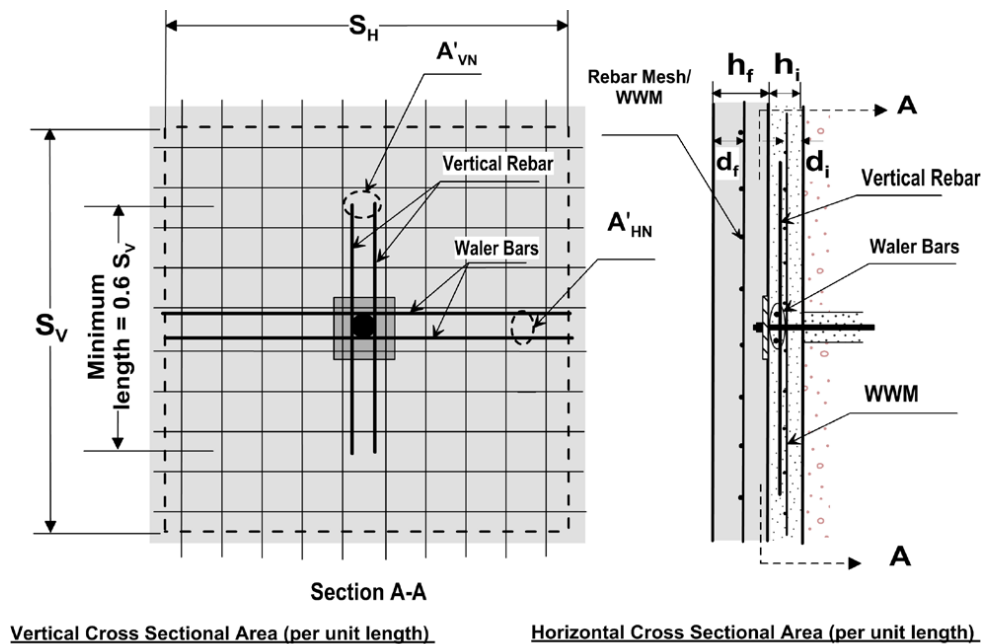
Nomenclature de renforcement pour le revêtement en flexion
